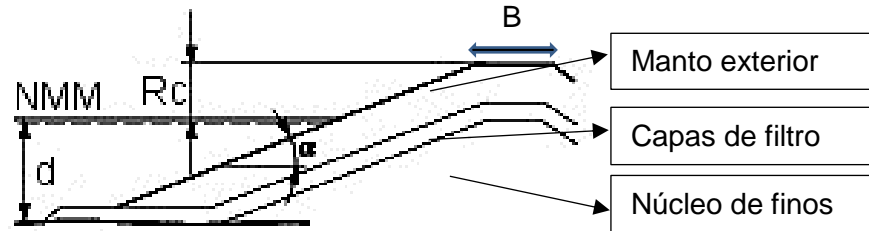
SECCIÓN TIPO DE ESCOLLERA DE PROTECCIÓN. FUENTE: (USACE, 2002).
